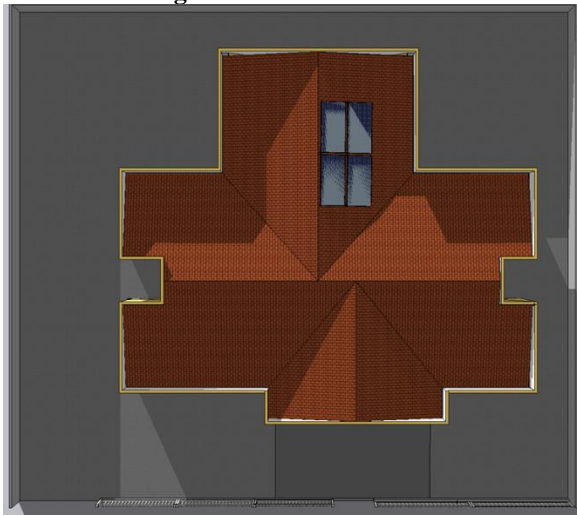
Vista superior da disposição dos módulos no telhado.
